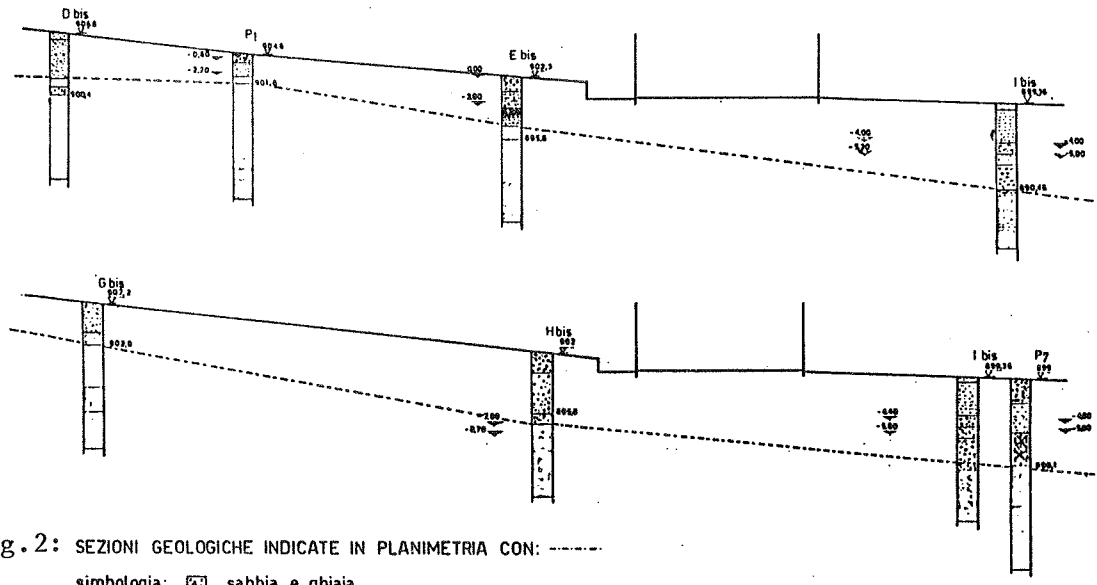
SEZIONI GEOLOGICHE INDICATE IN PLANIMETRIA CON: - - - -
